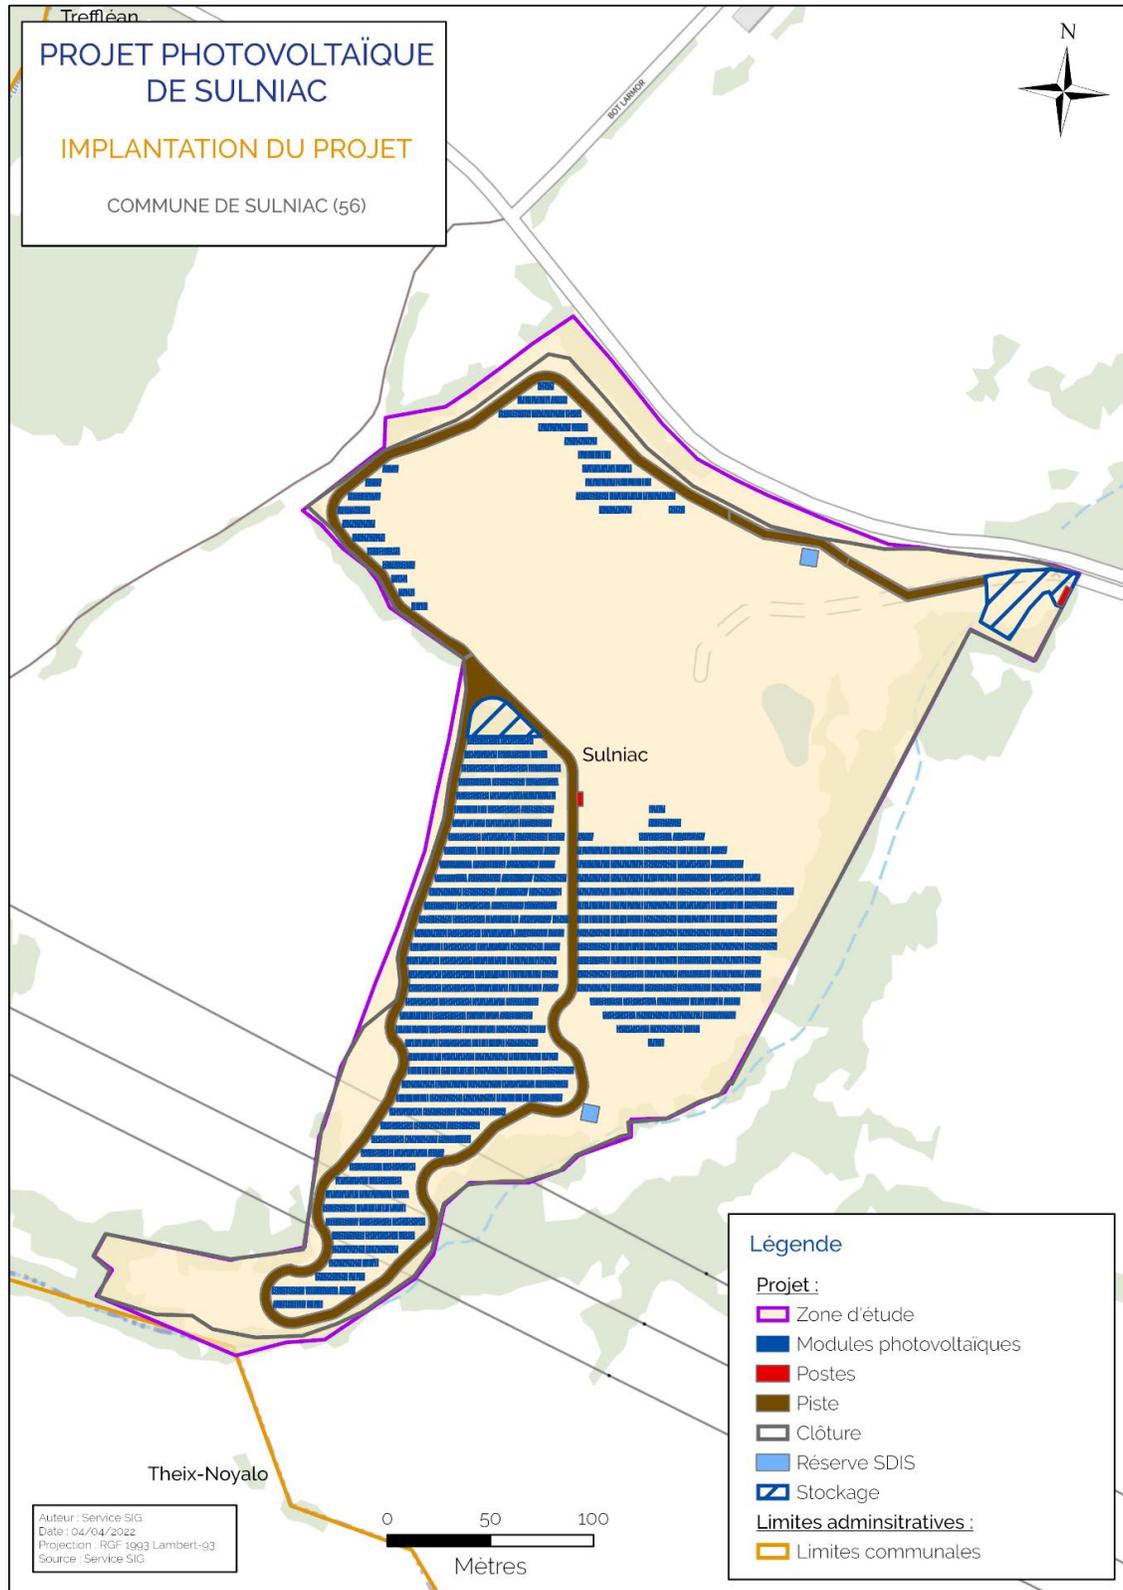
Plan d'implantation du projet de centrale solaire de La Fourchale
